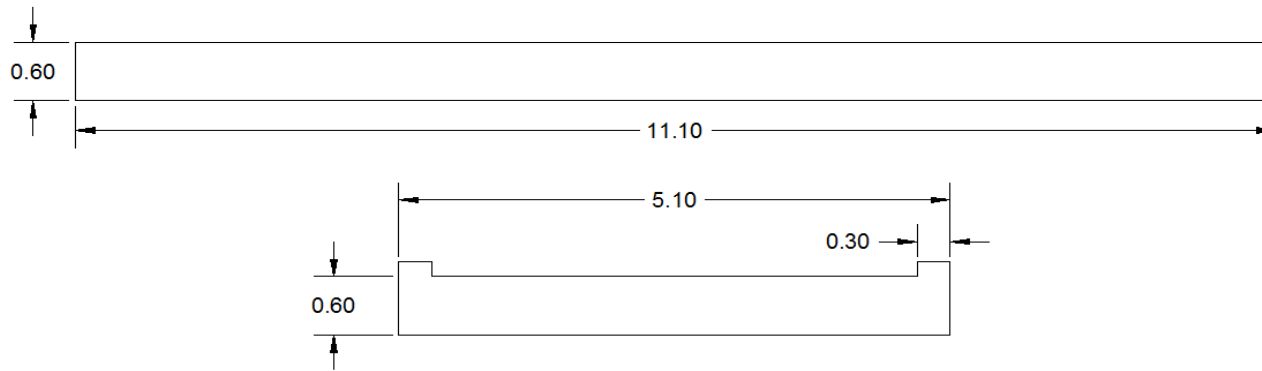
Superestructura losa simplemente apoyada en concreto.
